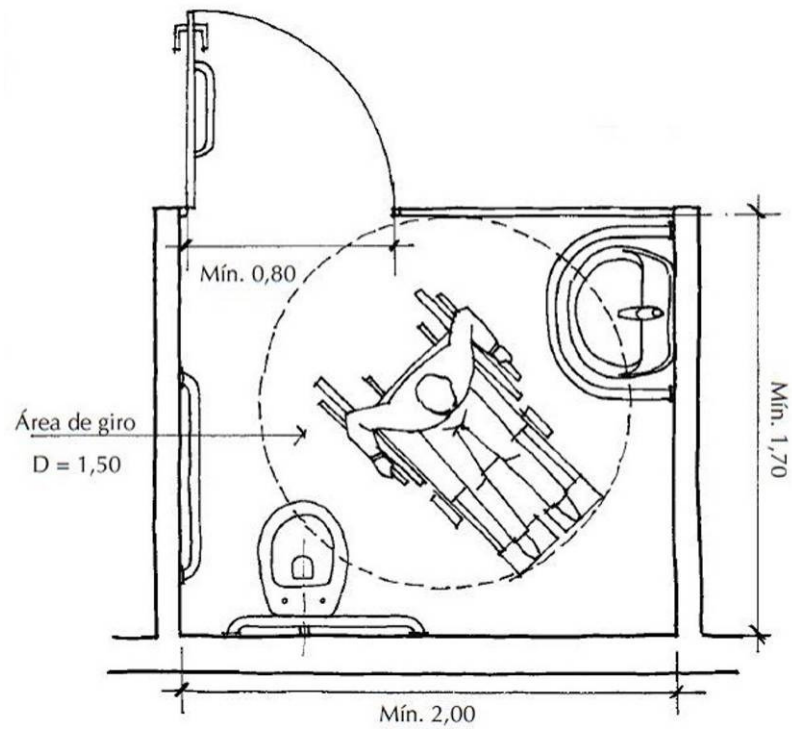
Sanitário com área de giro adequada (SMPED, 2008).
